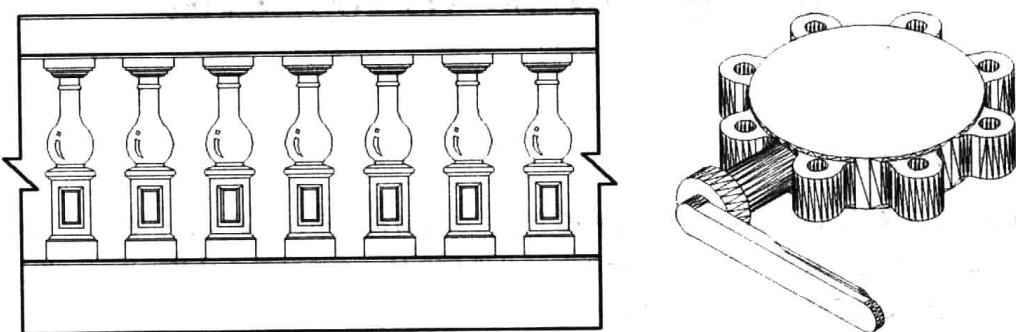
利用 AutoCAD 绘制的平面图形和三维图形
